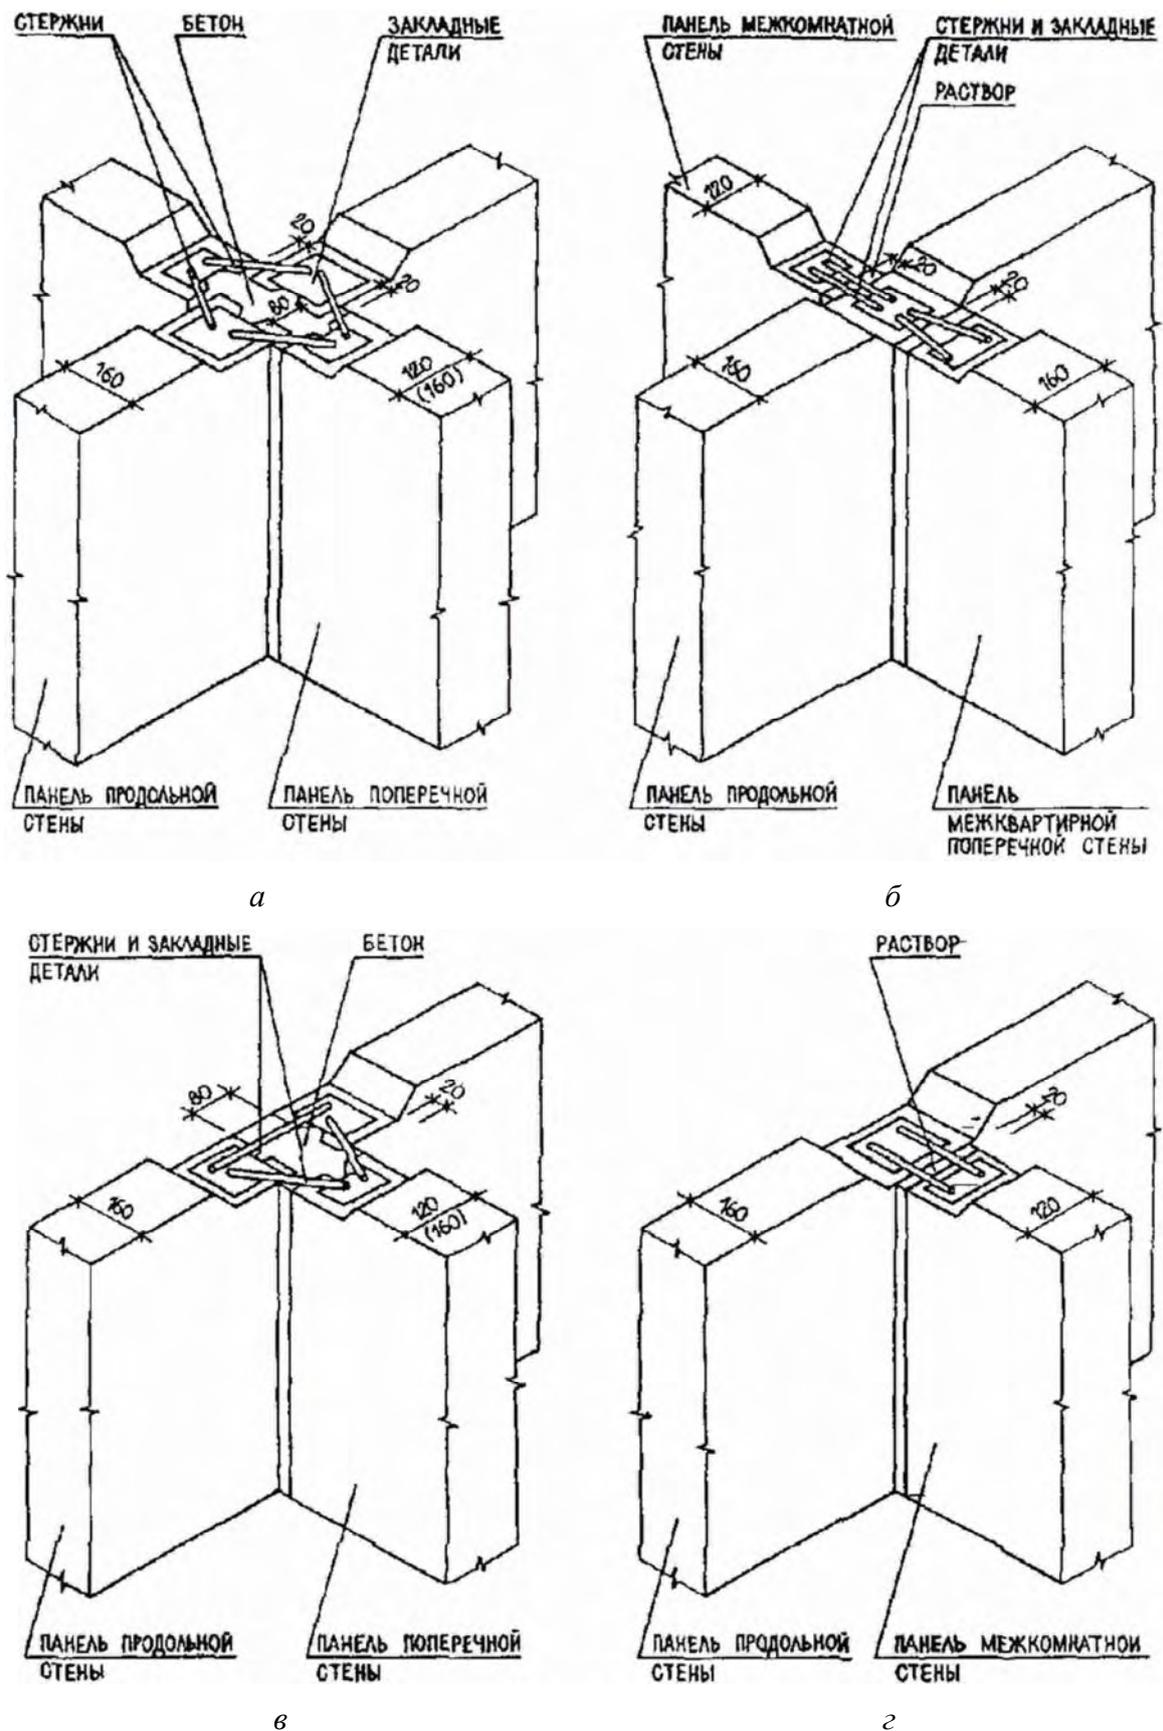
Вертикальные стыки панелей внутренних стен: а, в — стыки панелей поперечных и продольных стен; б, г — примыкание панелей поперечных стен к продольной стене (условно не показана приварка закладных деталей)
